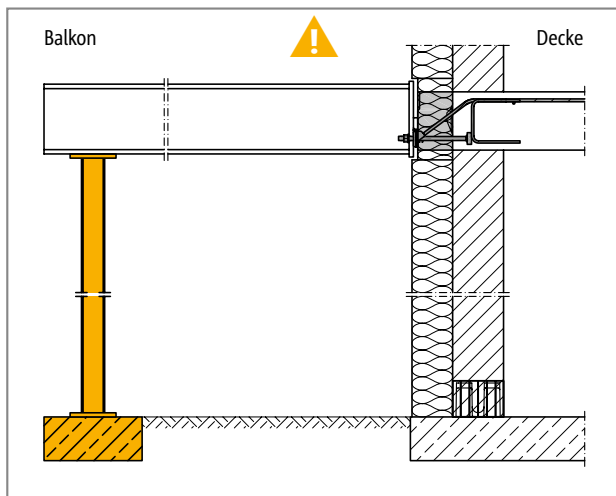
Schöck Isokorb® Typ QSXT: Stützung durchgängig erforderlich
